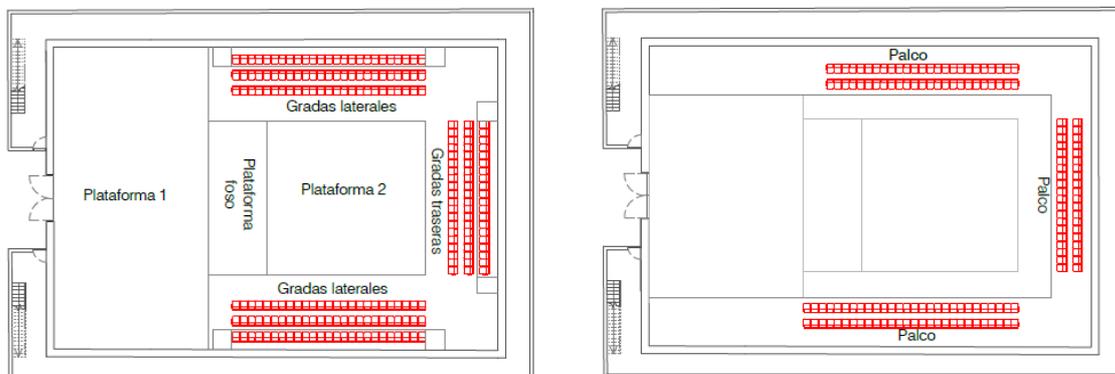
Planos de las plantas baja y alta en configuración 3/4 Arena. Esquema de la autora
